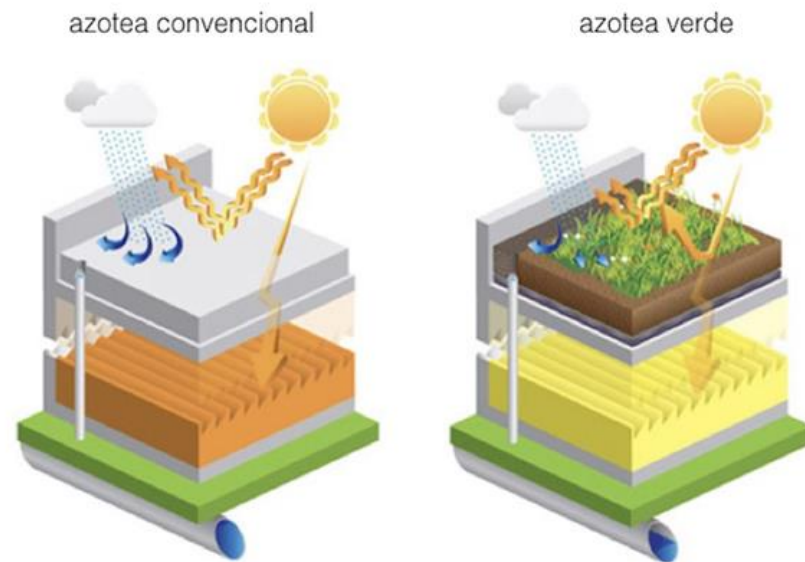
Cubiertas verdes. Adaptado de haus, s.f.
